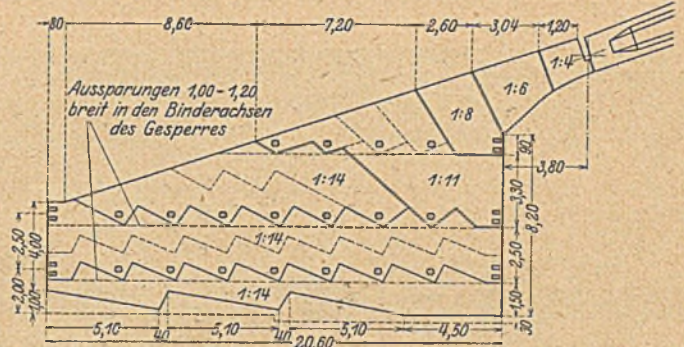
Betonierungsvorgang beim Widerlager mit Rücksicht auf Druckresultierende und Baugrubenaussteifung.
